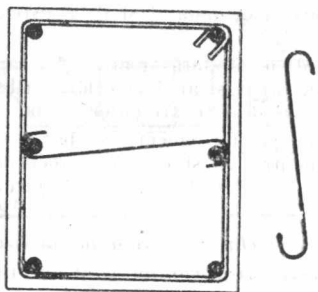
Agrafă și poziția ei în secțiunea unui stîlp din beton armat.
